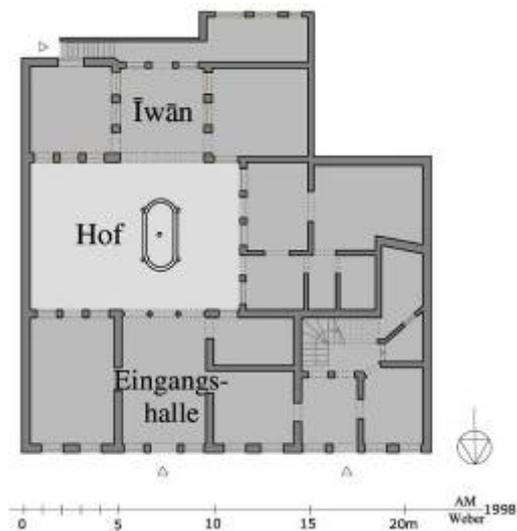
Bayt Bizm, Grundriss EG
